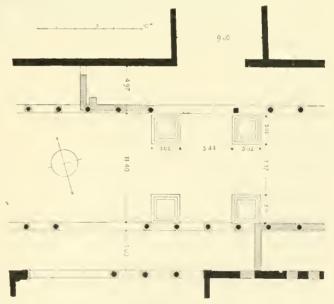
Grundriss der Arkadiane bei der Straßenkreuzung
